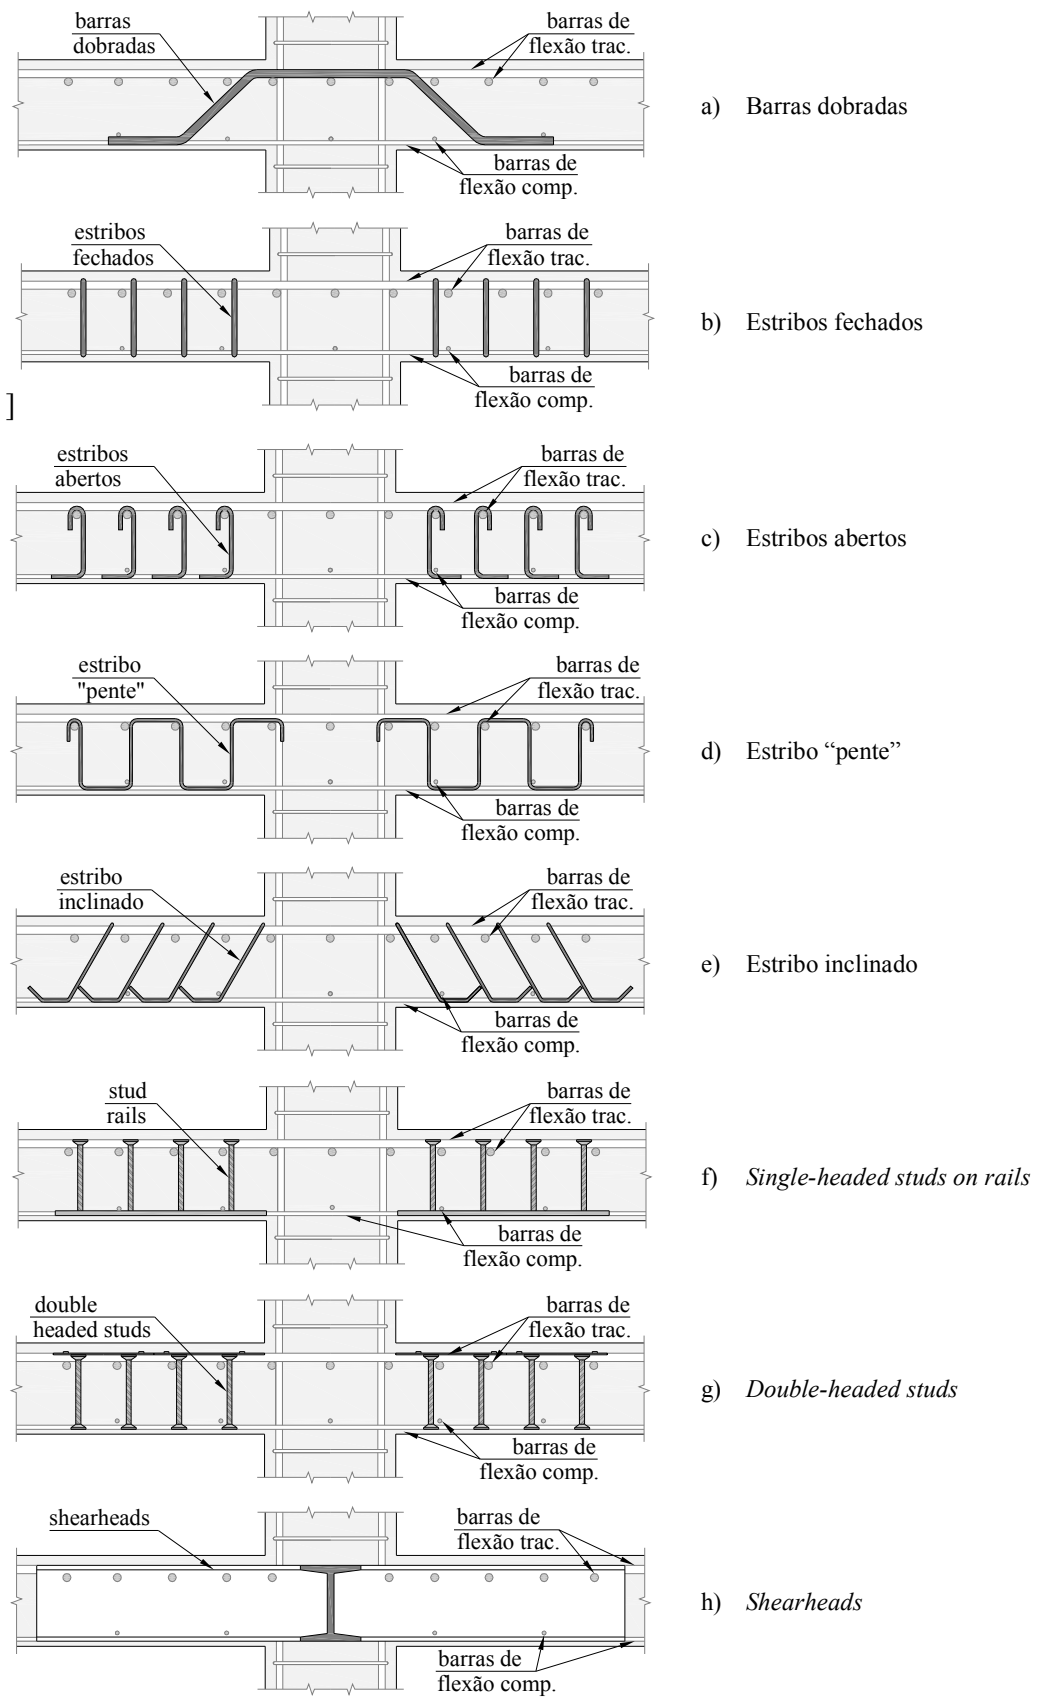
Tipos de armaduras de cisalhamento para lajes lisas
